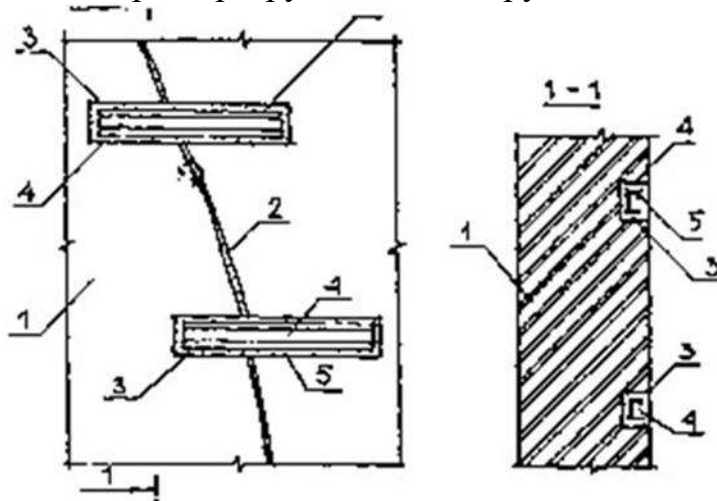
Заделка трещины в кирпичной стене способом установки шпонок из прокатного металла;
